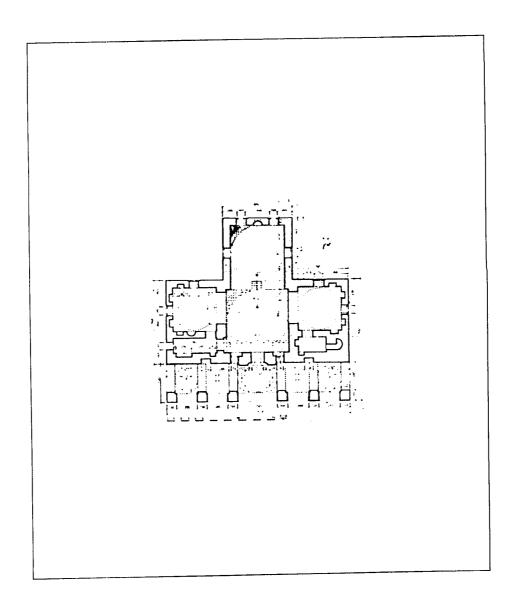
مسقط أفقي لمسجد Mezit bey في أدرنة (عن : أصلان أبا)
